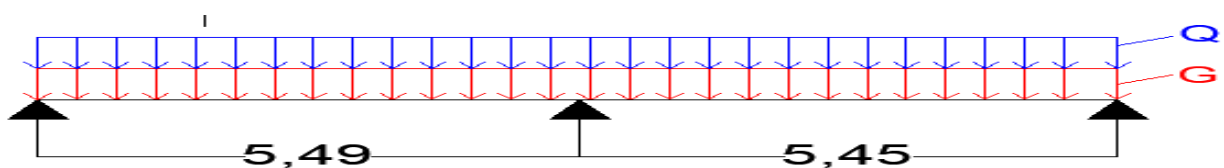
schéma statique de la poutrelle type 13 (méthode forfaitaire)
